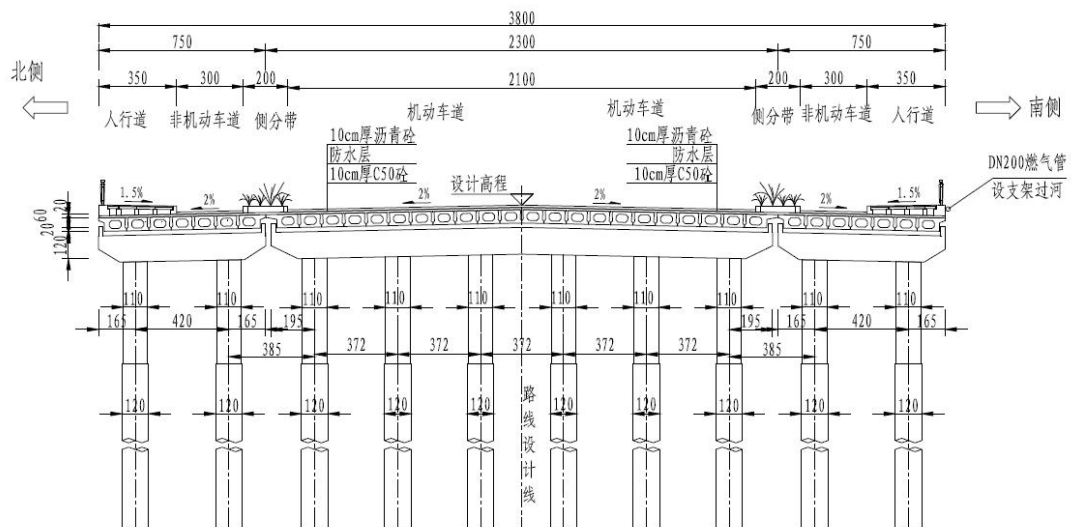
万兴路（三环东路-亚太路）段——桥梁横断面图
